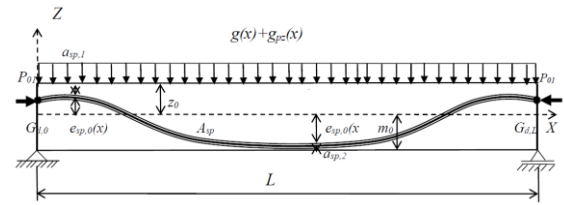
Схема для расчета постнапряженного элемента перекрытия для стадии создания натяжения арматуры
